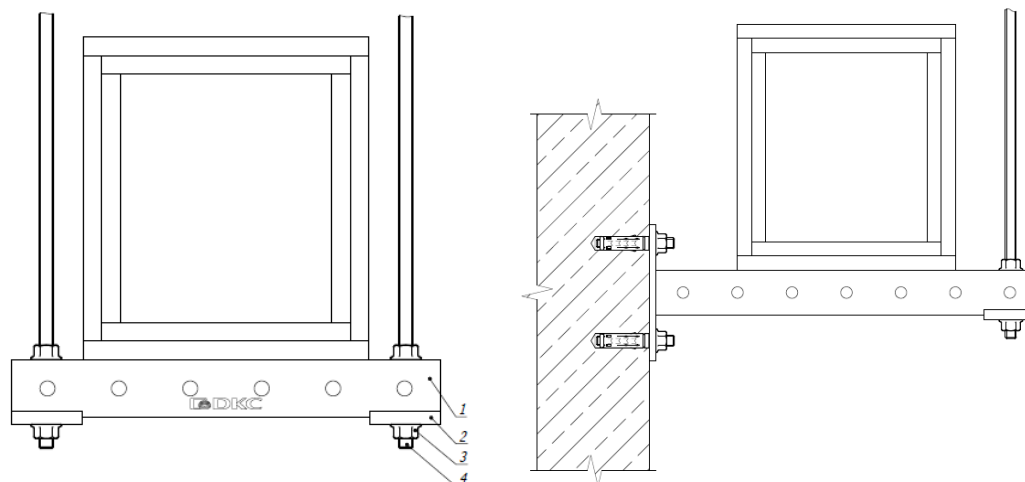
Крепление короба с четырьмя стенками к несущей поверхности
